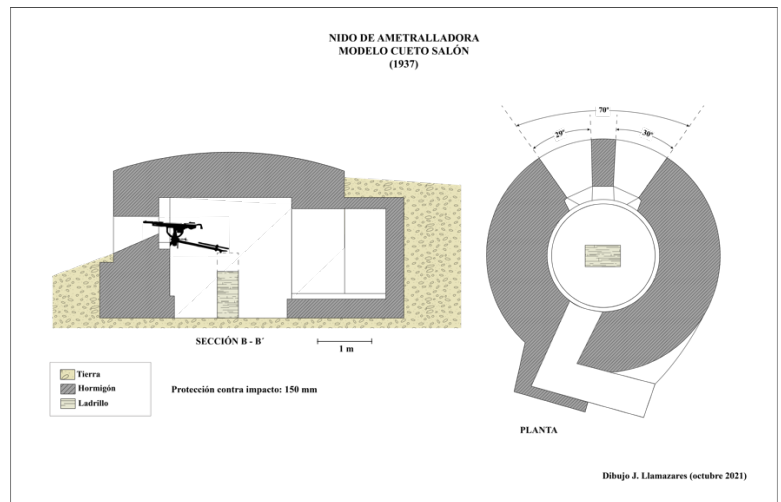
Plano en planta y sección del nido de ametralladora de Cueto Salón (La Valcueva, Matallana de Torío, León). Autor: Javier Llamazares.
